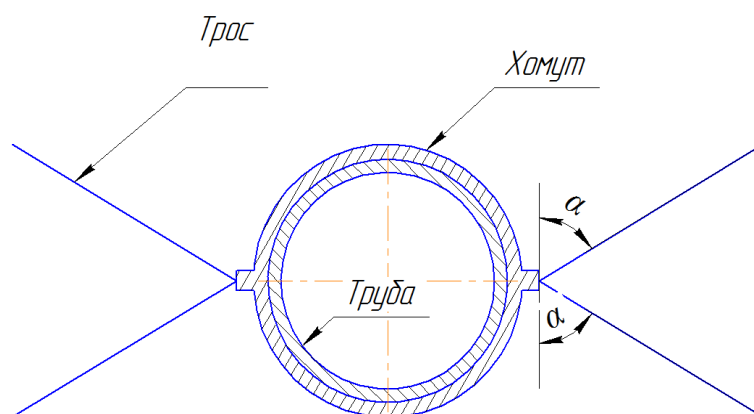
Схема крепления хомута к растяжкам подземной опоры
